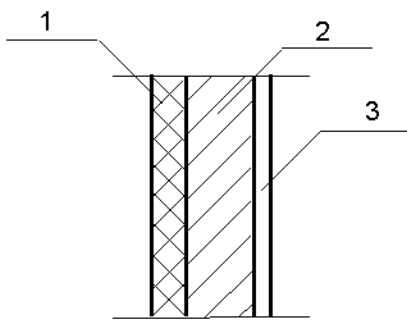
Конструкція стіни. 1- утеплювач мінераловатний; 2 – пінобетонні блоки; 3 – цементно-піщаний розчин.
